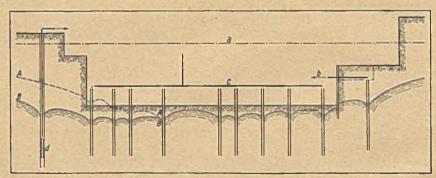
Langsschnitt durch die Baugrube mit Darstellung der Wirkung der Tiefbrunnen. a = Ungesenkter Grundwasserspiegel,
